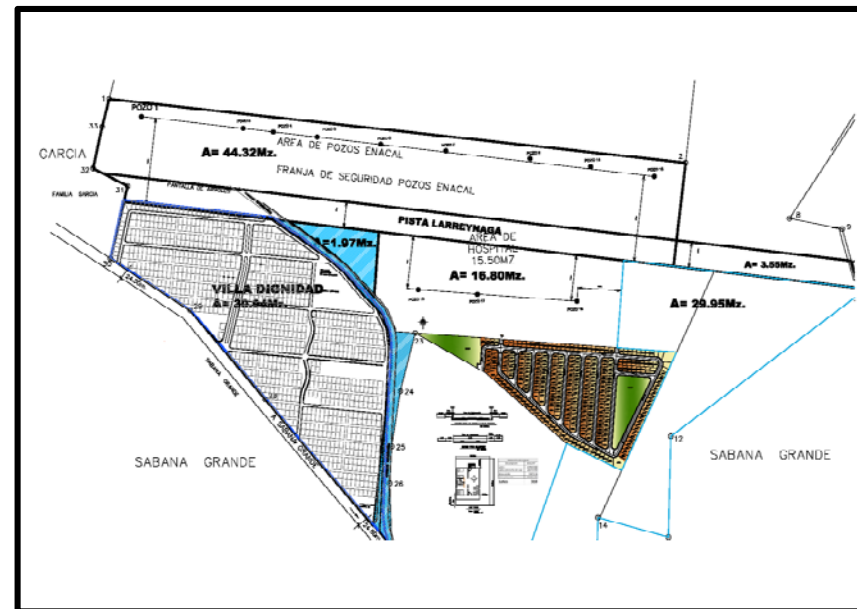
Plano de ubicación proyecto Monte Nebo, propuesta 2
